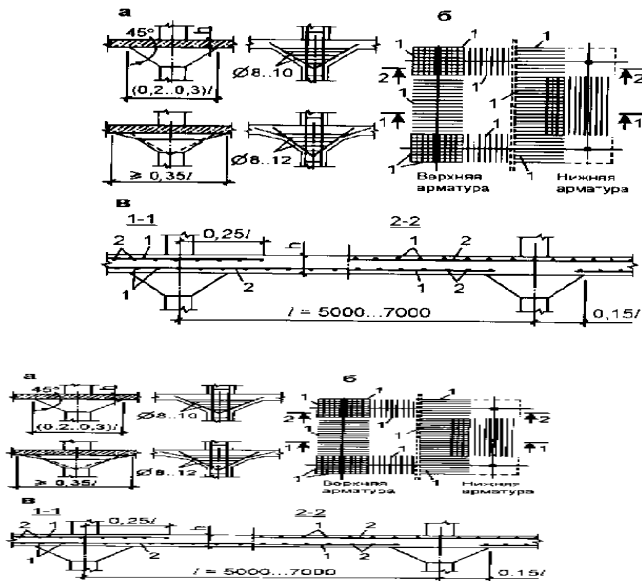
Монолитный безригельный каркас: а - капители колонн и их армирование; б - расположение рабочей арматуры в плите (план); в - фрагмент разреза каркаса с изображением армирования плиты; 1 - рабочая арматура; 2 - конструктивная арматура
